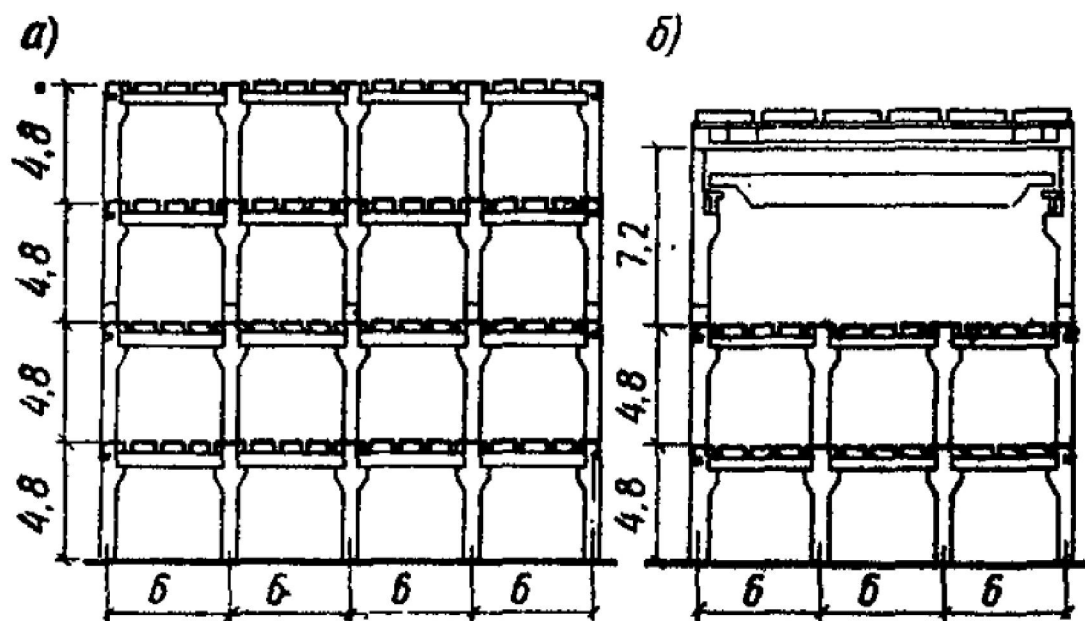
Конструкции многоэтажных промышленных зданий (а - регулярных; б - с мостовыми кранами в верхнем этаже) [1]
